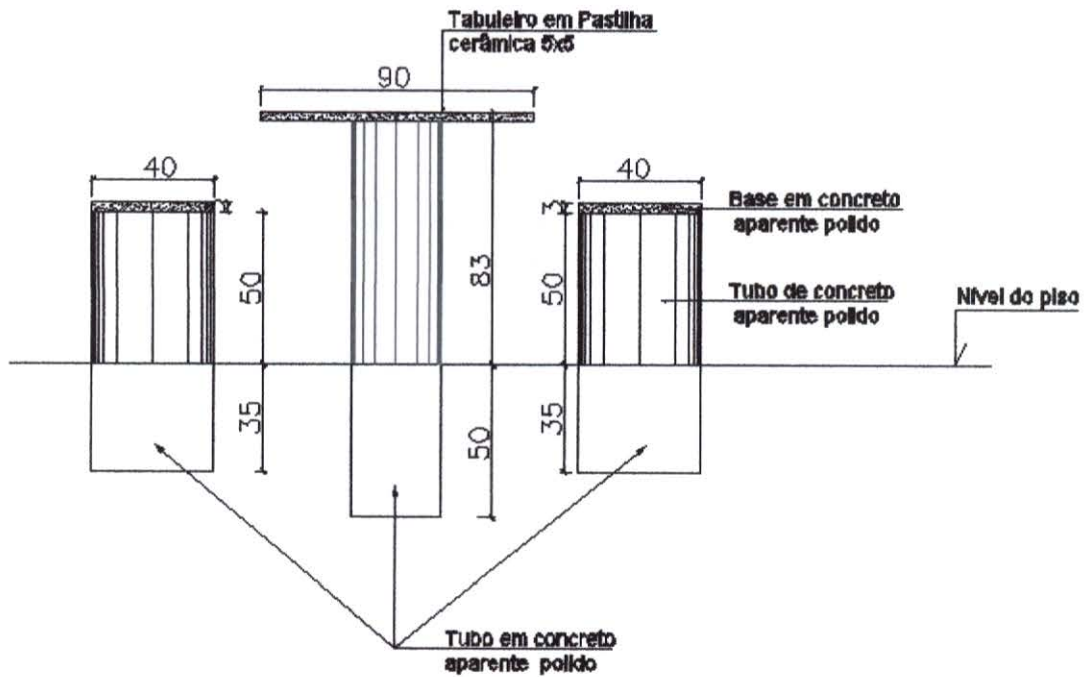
Ilustração em perfil da mesa de concreto com tabuleiros e bancos.
